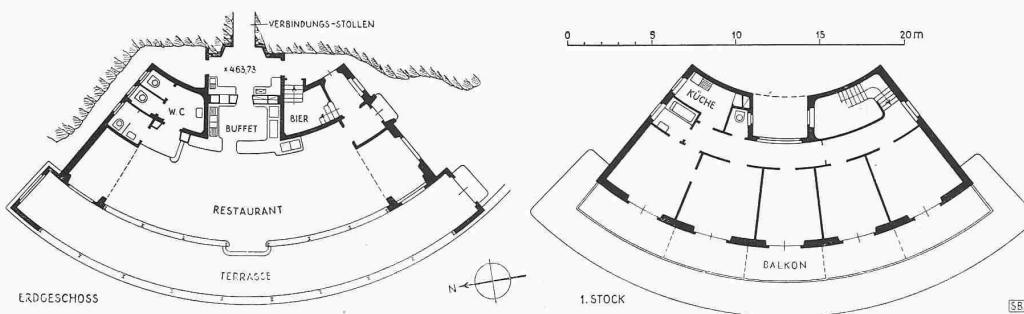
u. 18. Grundrisse 1:400. — Die Zimmer im 1. Stock können einzeln oder als Apartment vermietet werden
